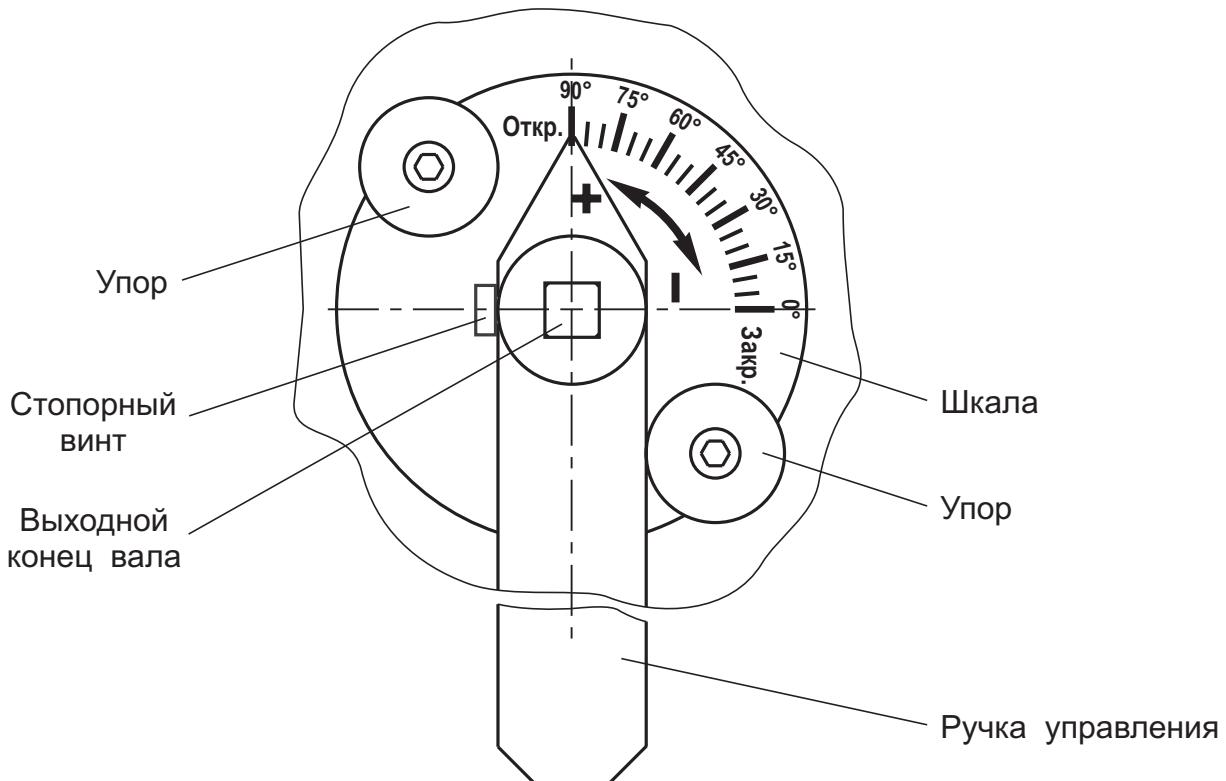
Заслонка регулирующая с ручным управлением (вид сверху)
